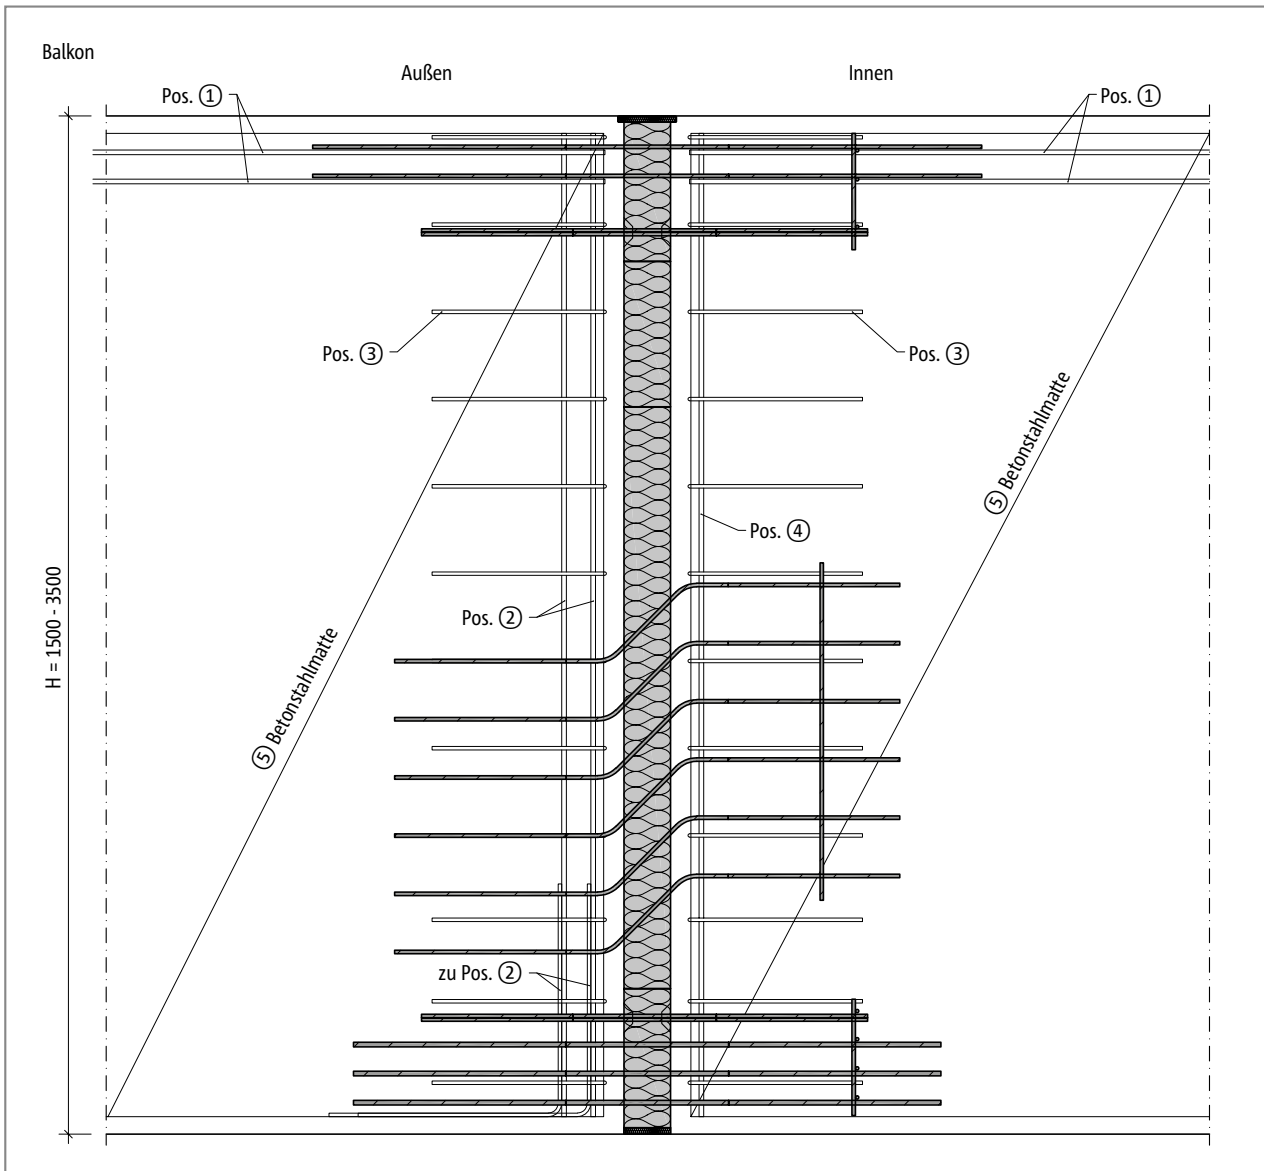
Schöck Isokorb® T Typ W: Bauseitige Bewehrung (Schnitt)
